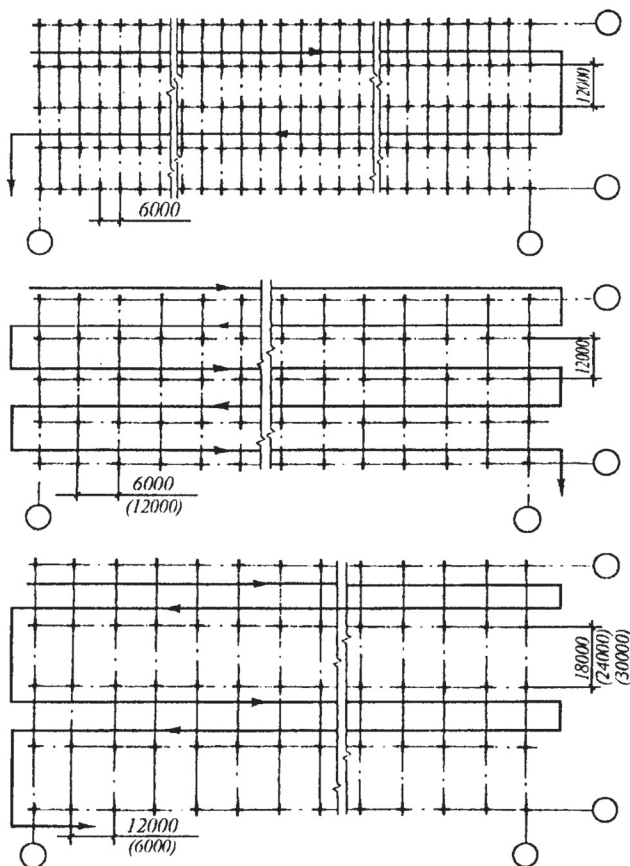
Схемы движения крана при установке колонн в пролетах 12, 18, 24 и 30 м
